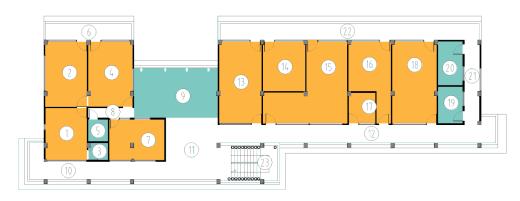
Planta Segundo Nivel Bloque No.1. Fuente: Equipo Diagnóstico.
